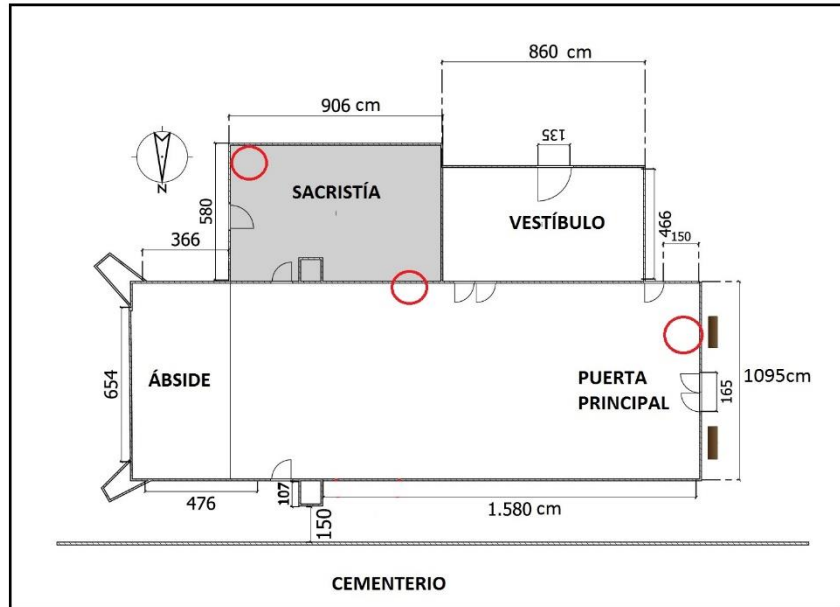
página 35. Plano del inmueble realizado por Sandra Brisa retocado con Illustrator.
